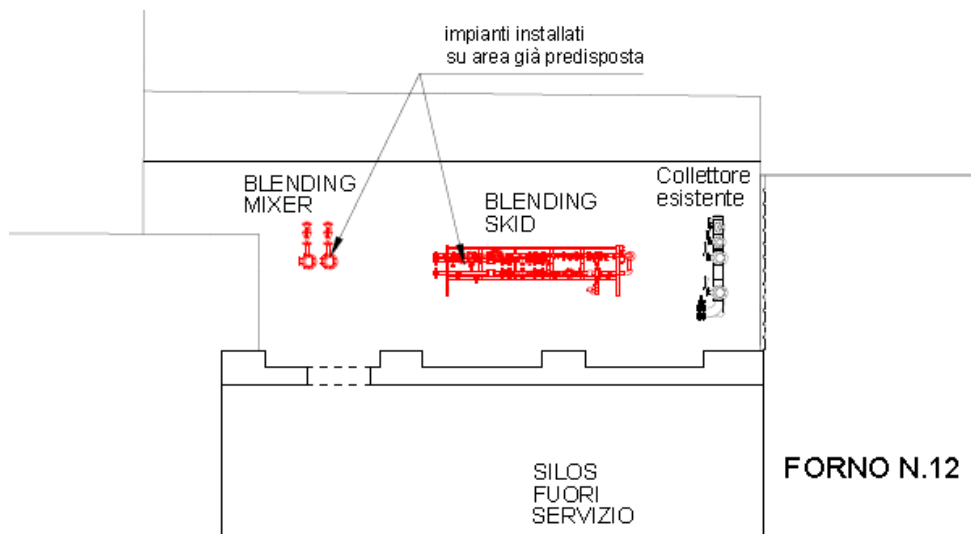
Layout di progetto – Dettaglio Zona 2 di intervento
